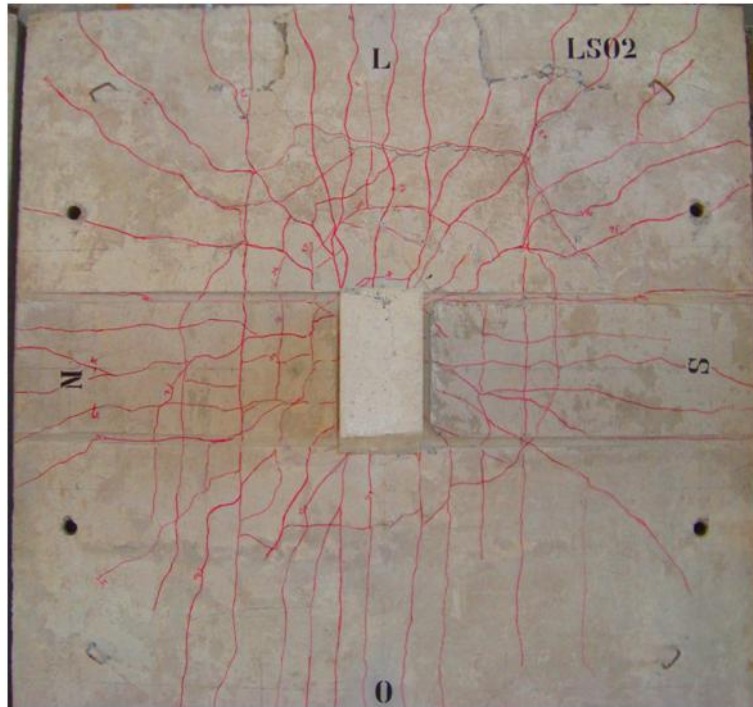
Padrão de fissuração do modelo LS02.
